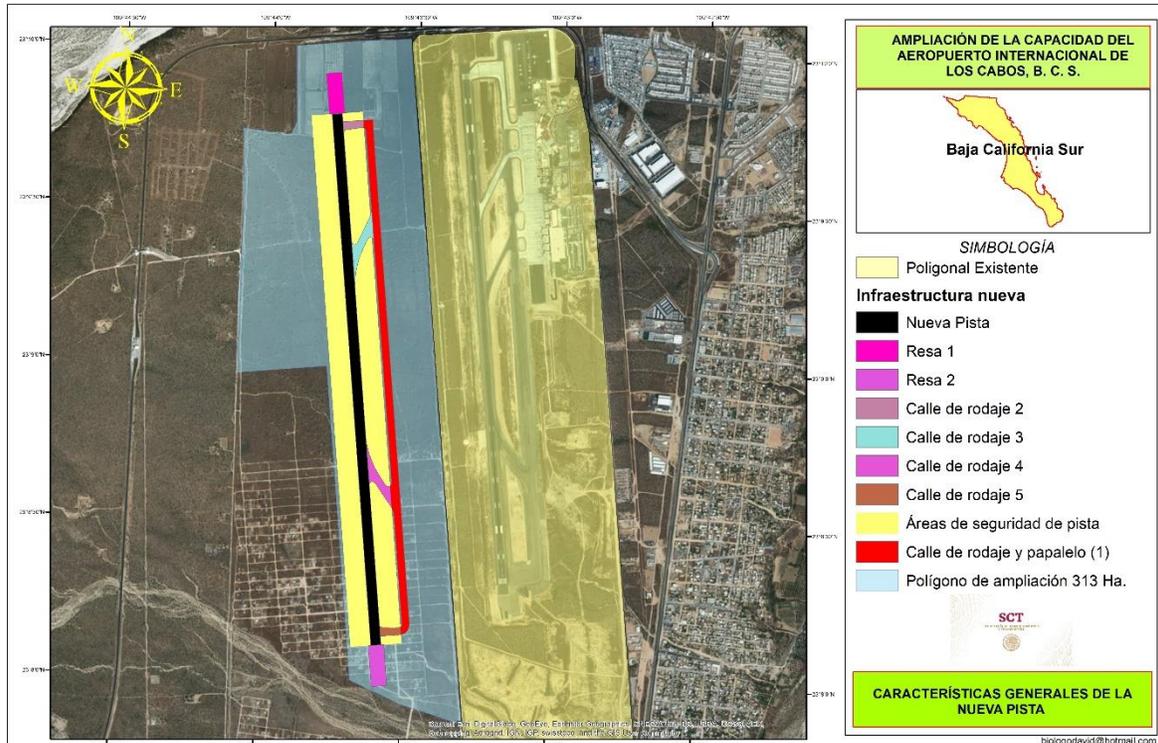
Vista general de la Nueva Pista que se pretende construir
